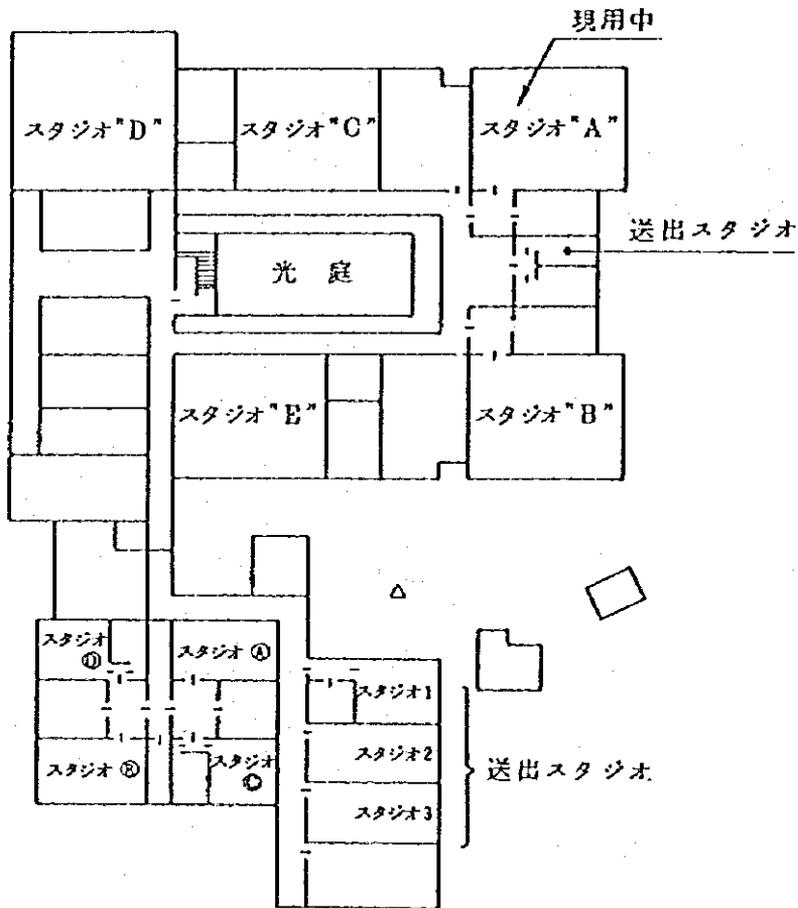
SNBCオンドルマンのスタジオ平面配置図
